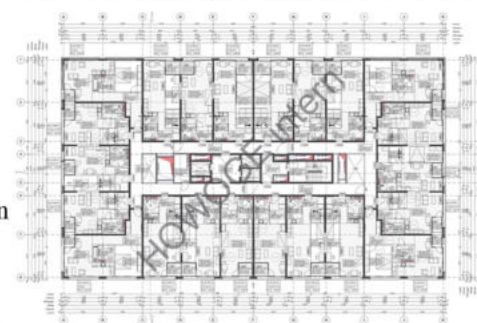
Grundriss Regelgeschoss (HOWOGE)
